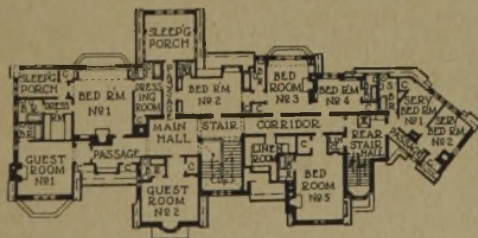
Grundriß des Herrenhauses. Obergeschoss.
